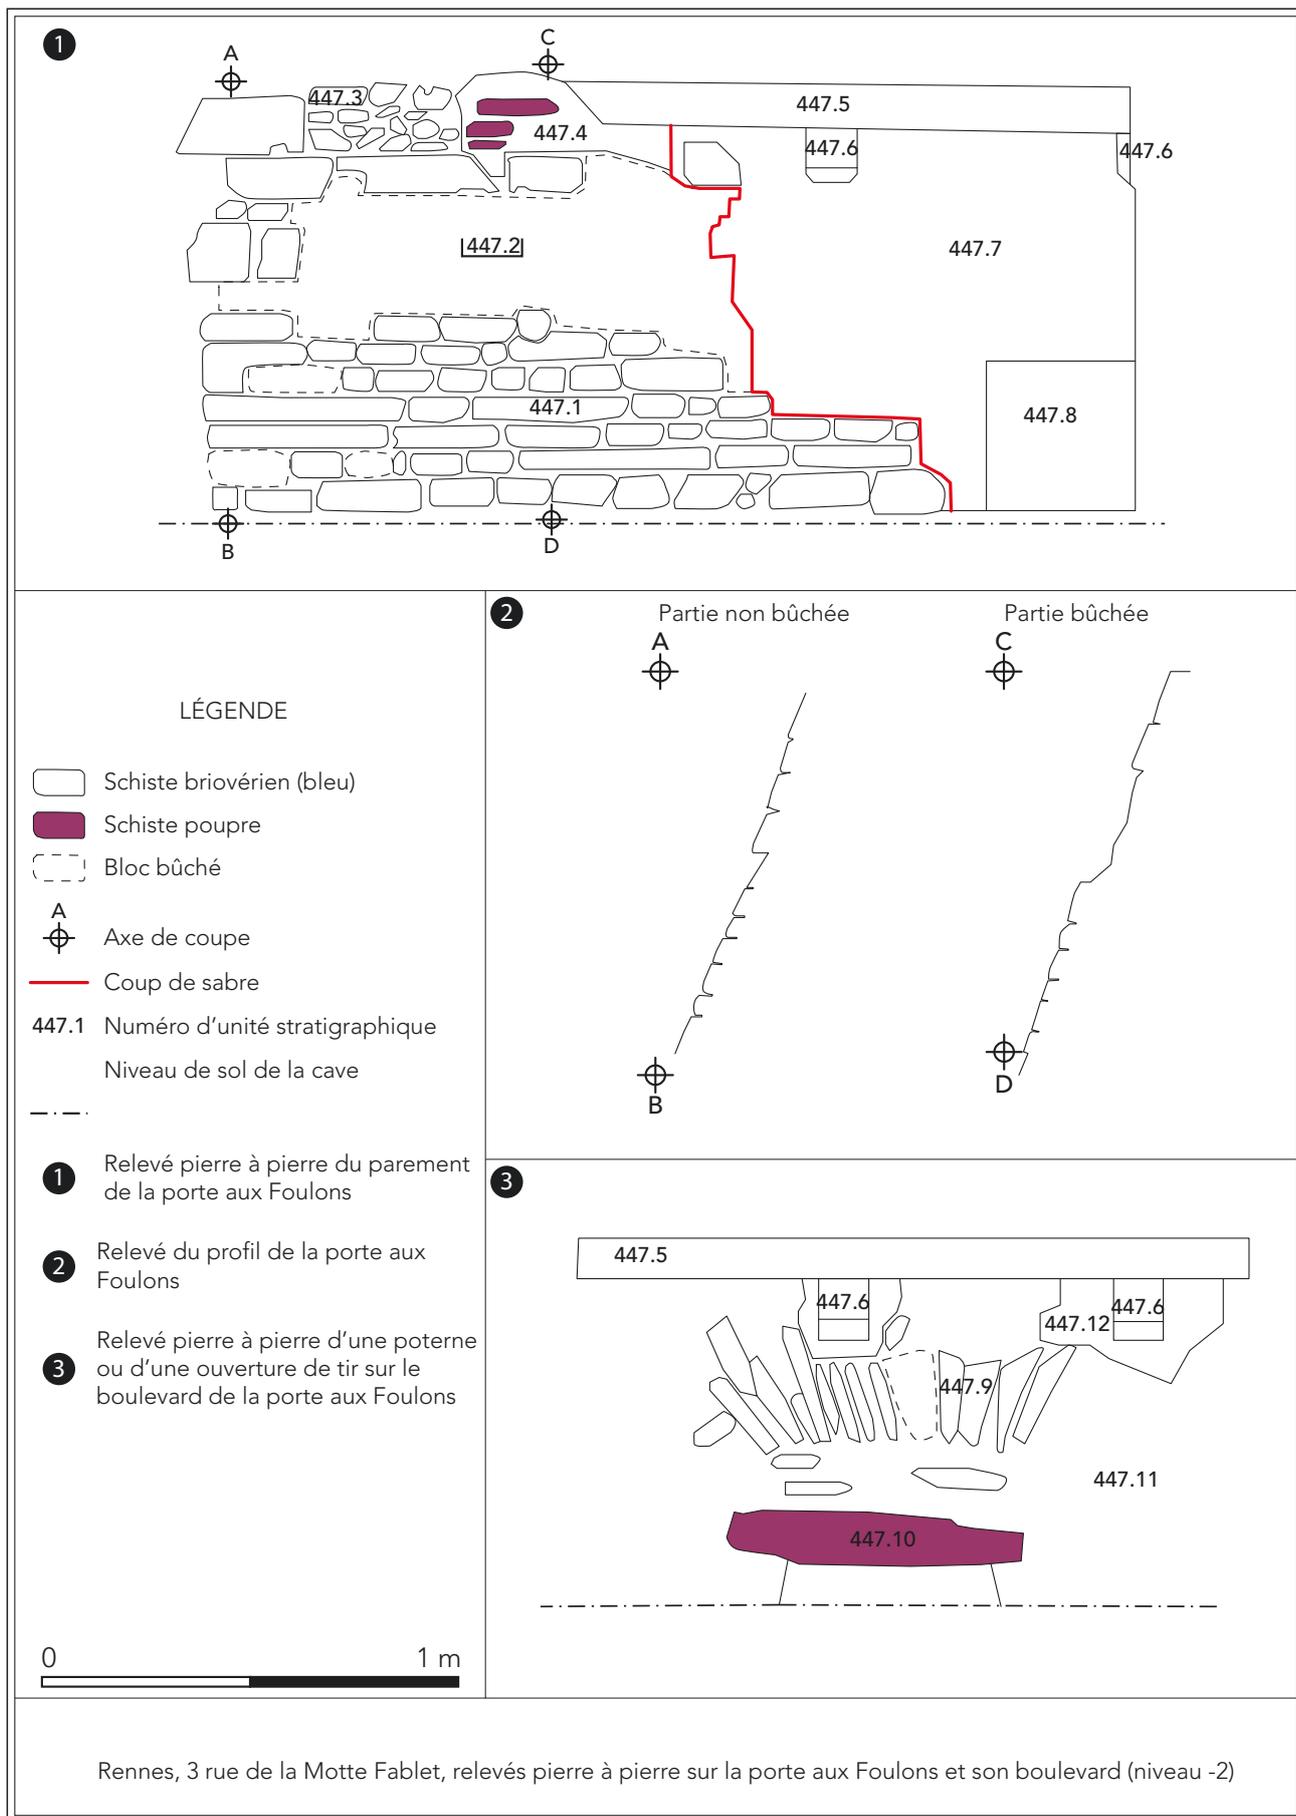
3, rue de la Motte Fablet, relevé pierre à pierre sur la porte aux Foulons et son boulevard (niveau -2)
